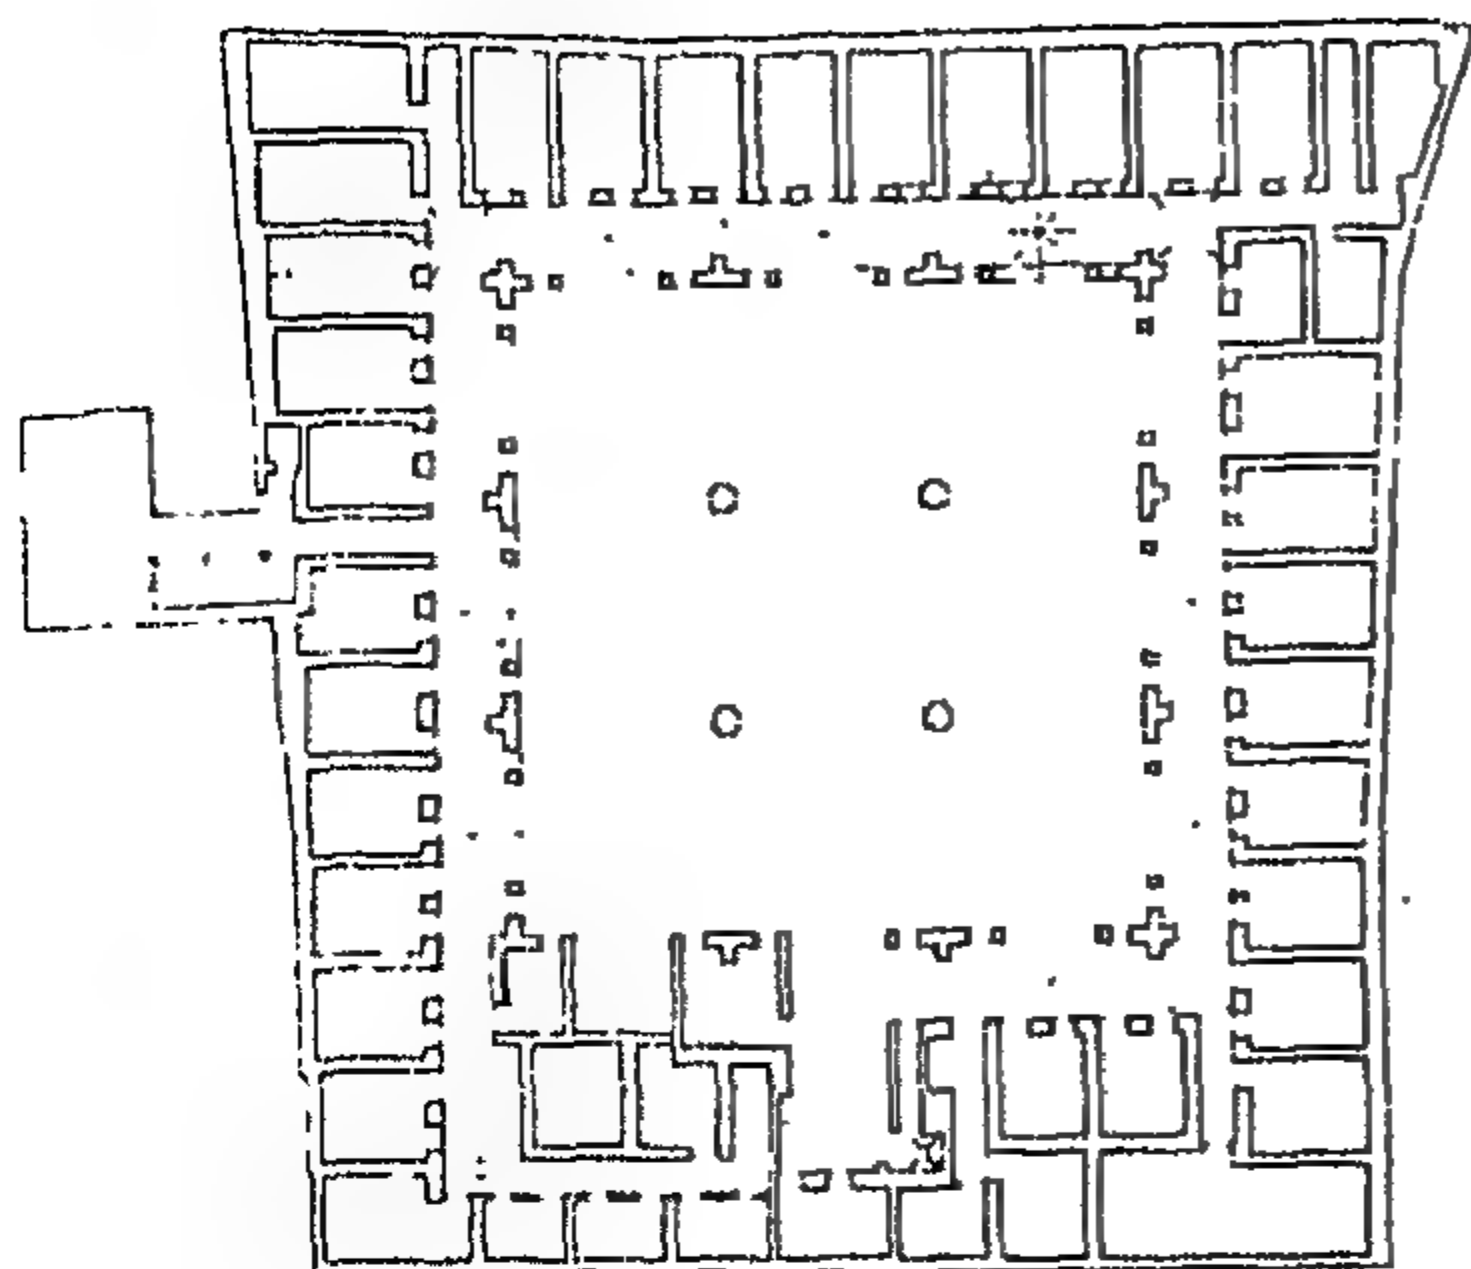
مسقط أفقي لحمام السنانية بدمشق . (عن : ايكوشار) .
